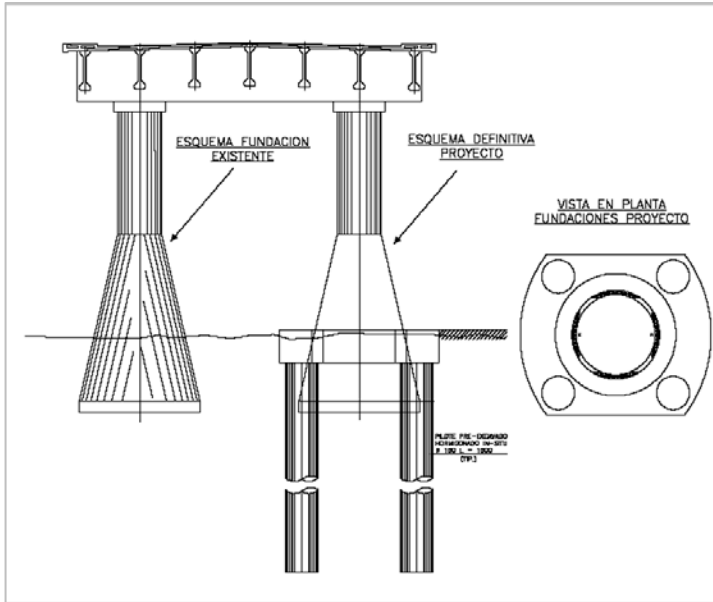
Vista lateral y en planta de fundaciones existentes y nueva fundación.
